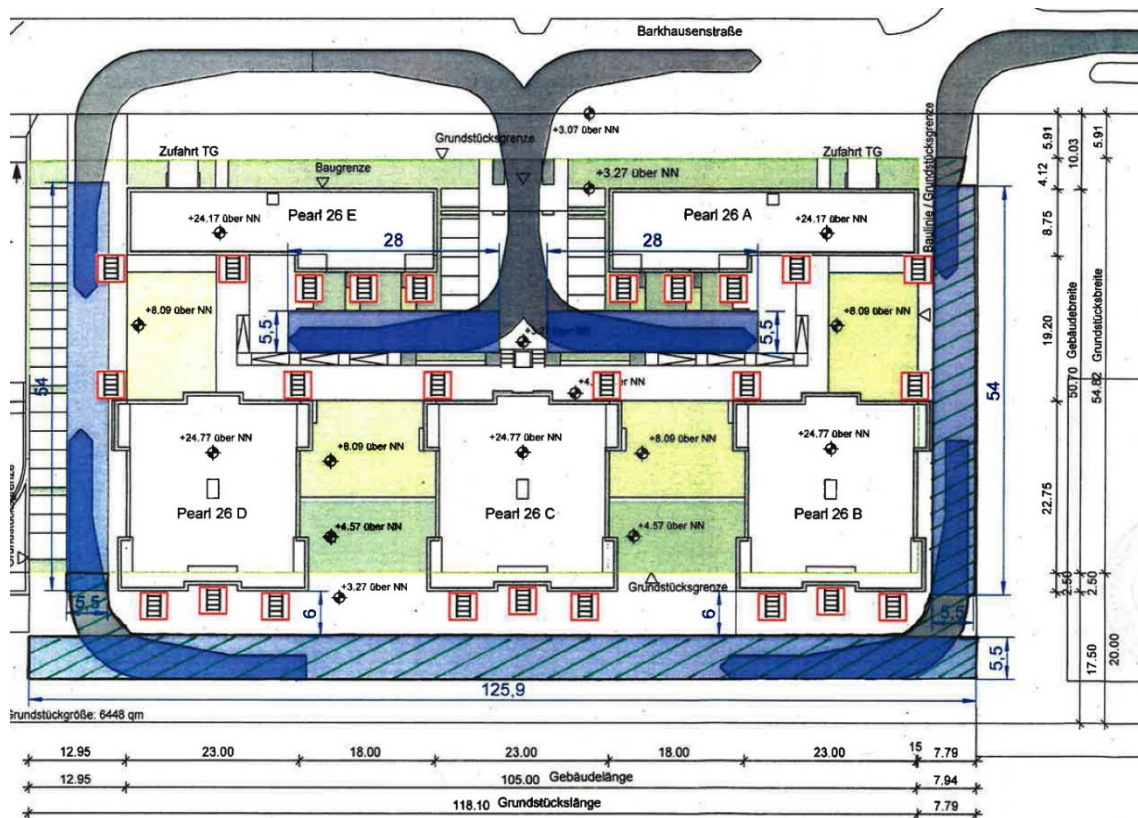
Feuerwehraufstellflächen Barkhausenstraße 26a-e
